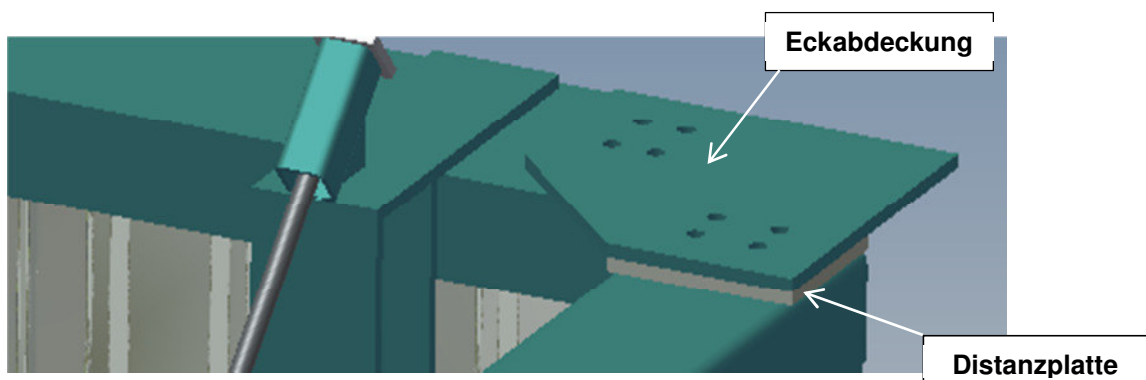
Wandecke mit Distanzplatte zum Höhenausgleich
